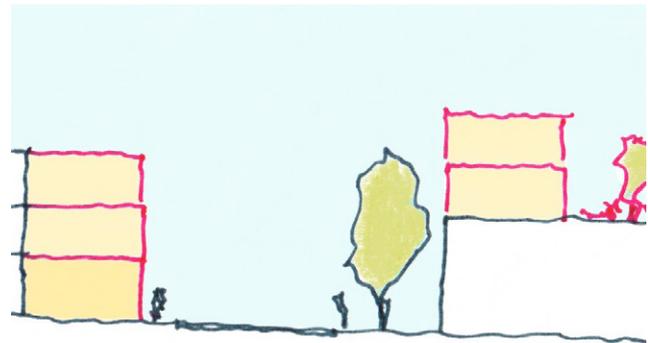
Exemplarische Schnitte Straßenraum sowie additive Ergänzungen (Eigene Darstellung)
